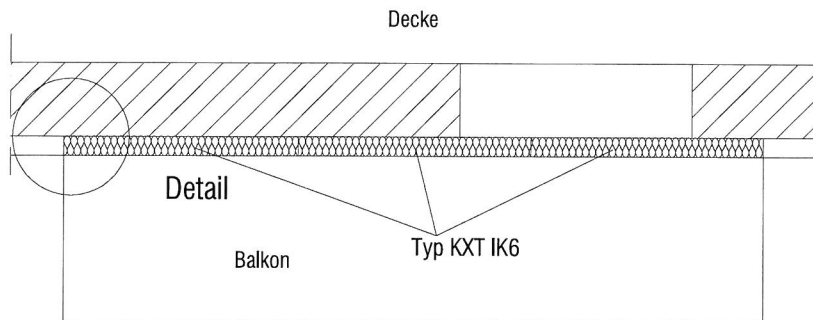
Einbausituation Schöck Isokorb Typ KXT IK6
